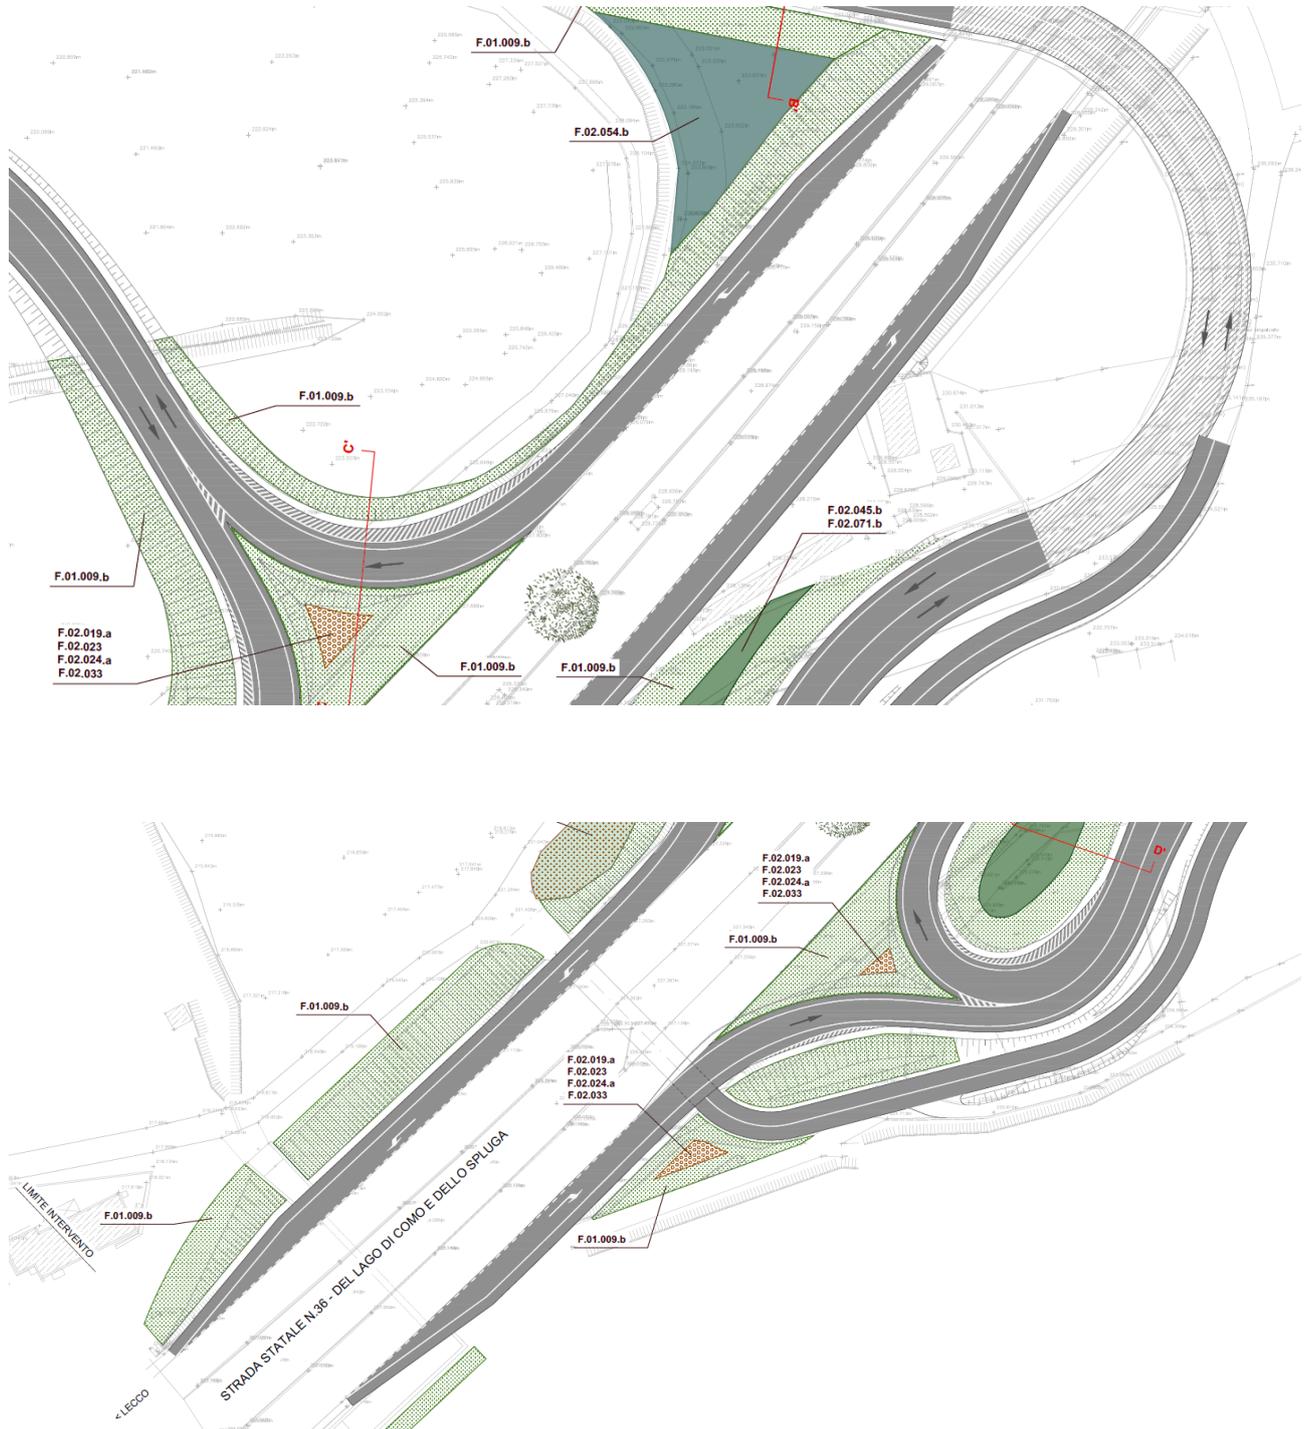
Stralcio Planimetria generale interventi di sistemazione a verde e inserimento paesaggistico/ambientale (area svincolo SS36 – raccordo viabilità SP72)
